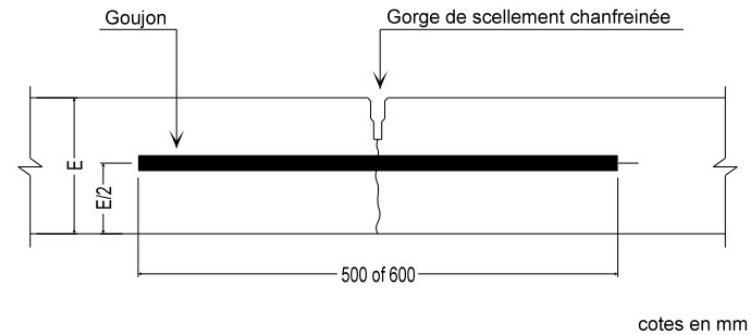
6.1.3.3.1.3 Joints de construction transversaux
